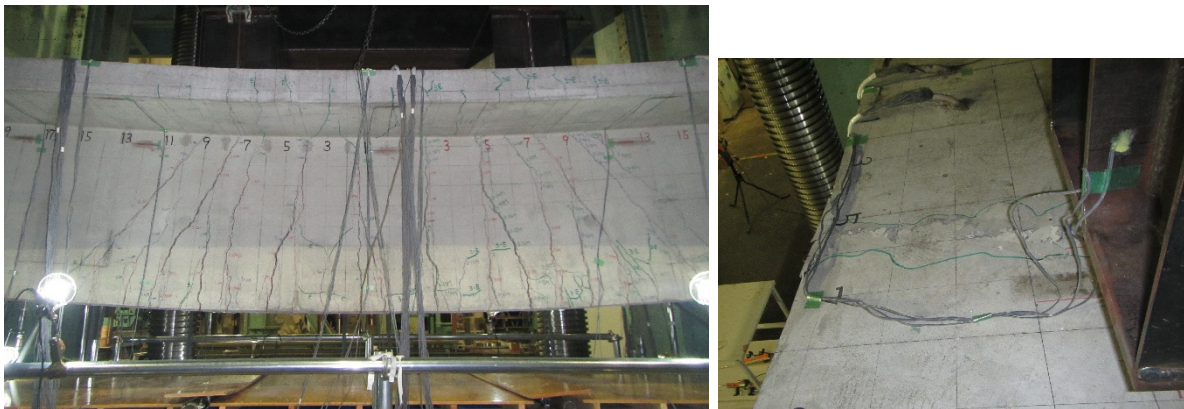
ケーブル破断側のウェブ側面の破壊状況と上フランジ上面の圧壊状況（右）（供試体 G0）
